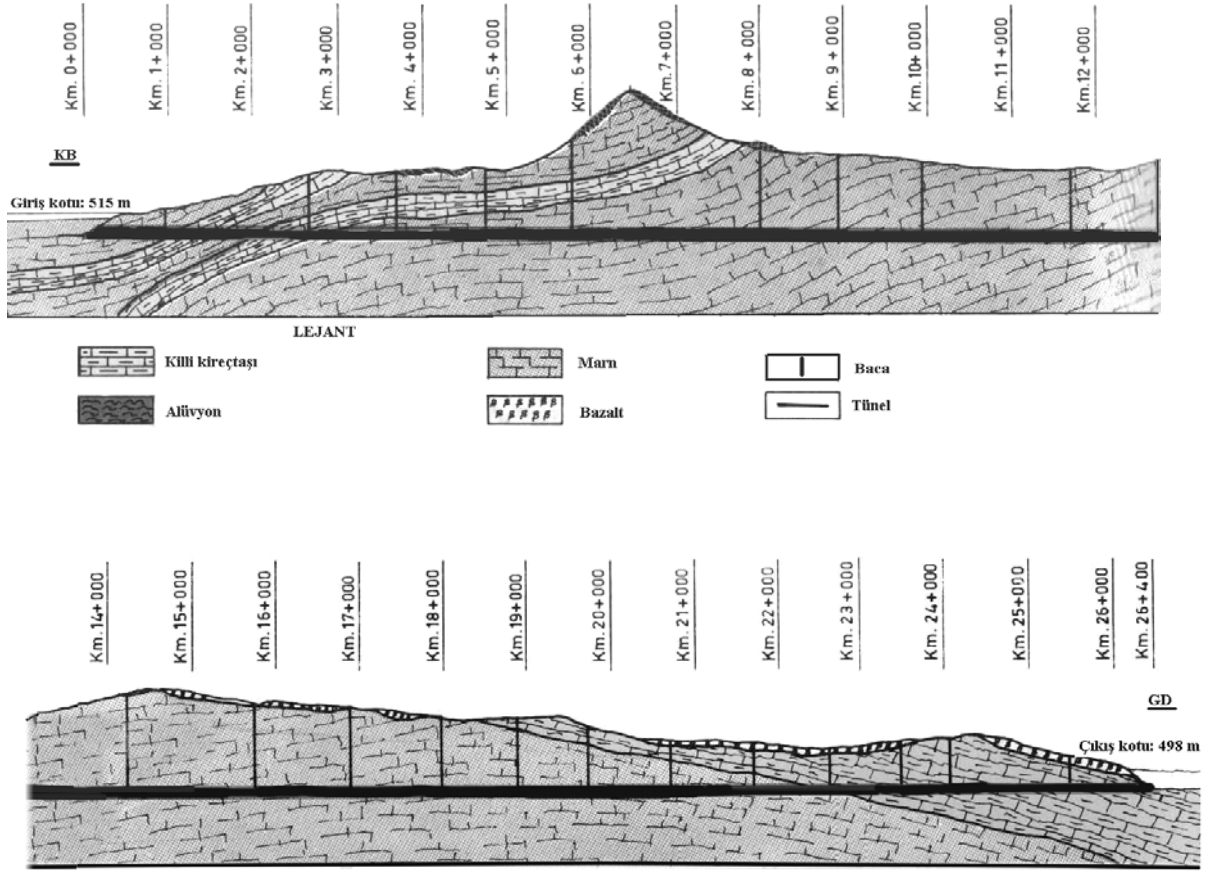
Şanlıurfa tünelleri genel vaziyet planı (ölçeksiz)
